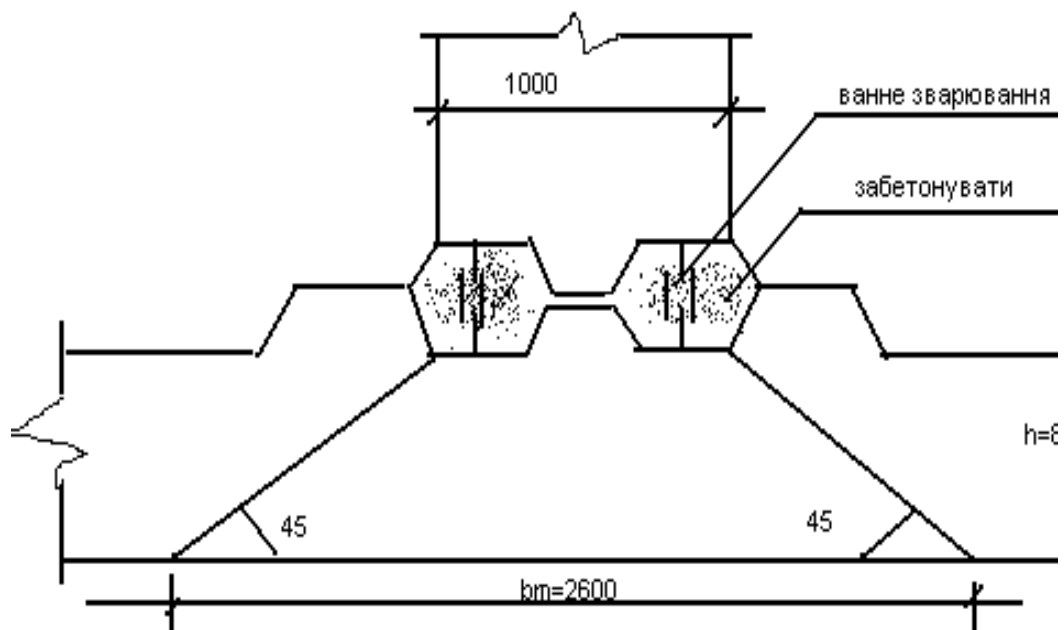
Типова розрахункова схема продавлювання фундаментної плити
